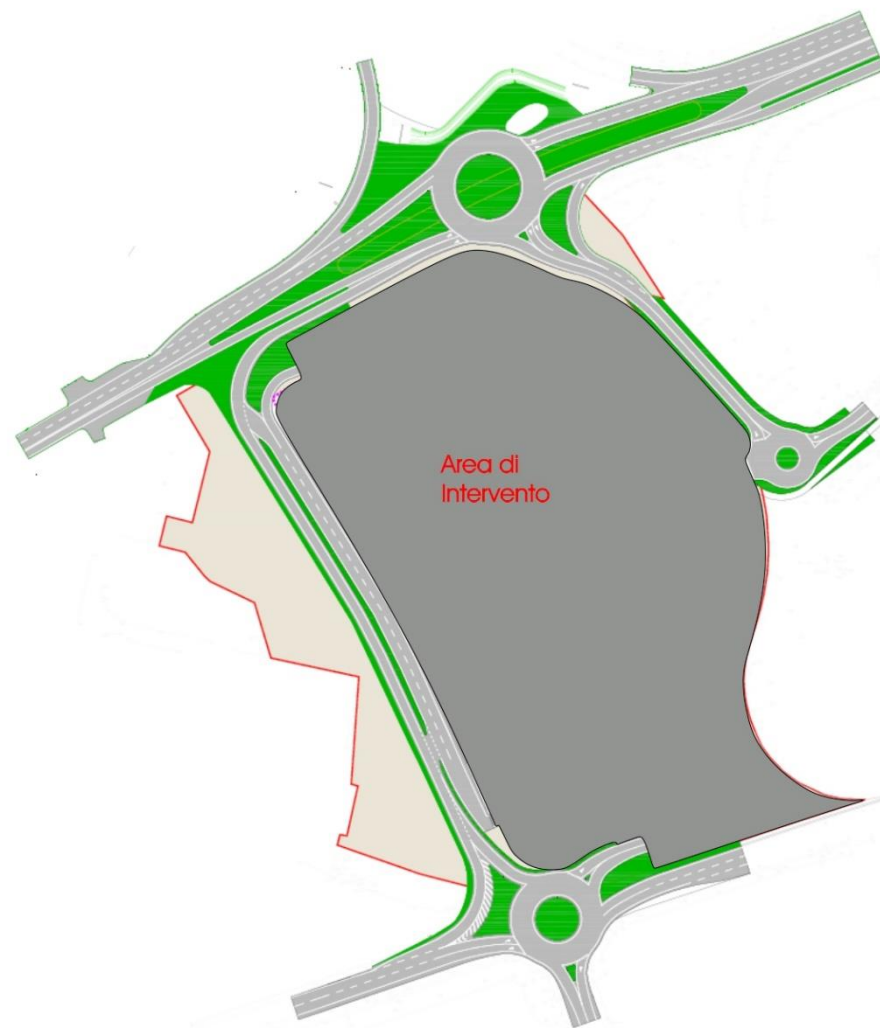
Interventi viabilistici previsti – Ipotesi 2 – Planimetria di progetto
